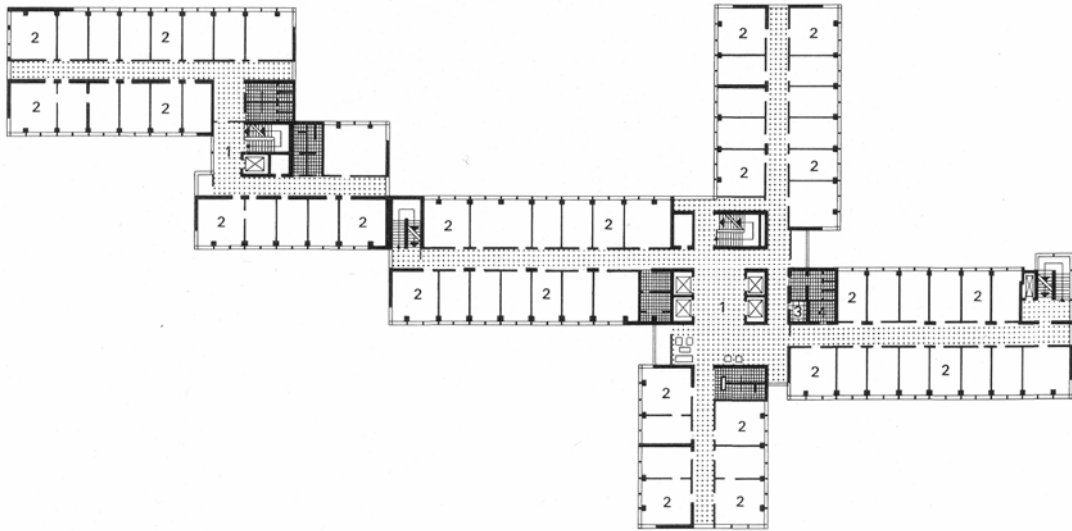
Grundriss eines Bürohauses in Berlin (1967) in Skelettbauweise [Nagel und Linke, 1969]
